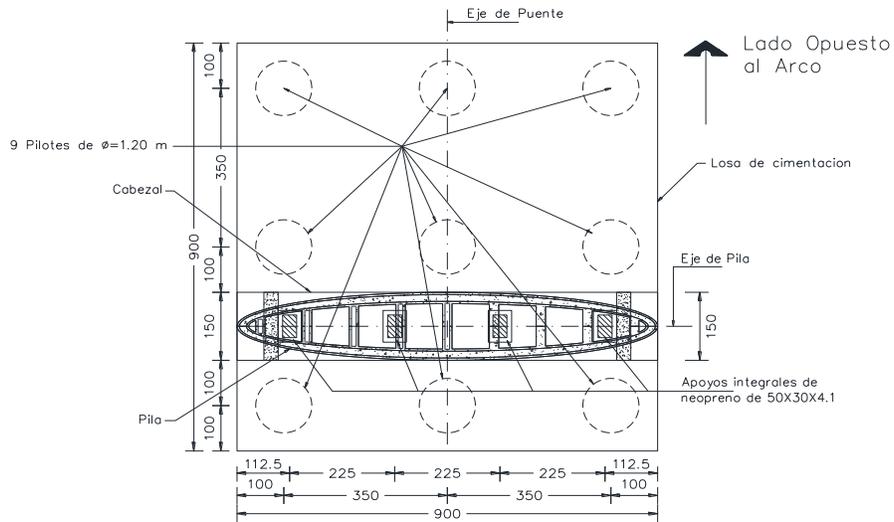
Vista en planta de pilas No. 2 y 3.
